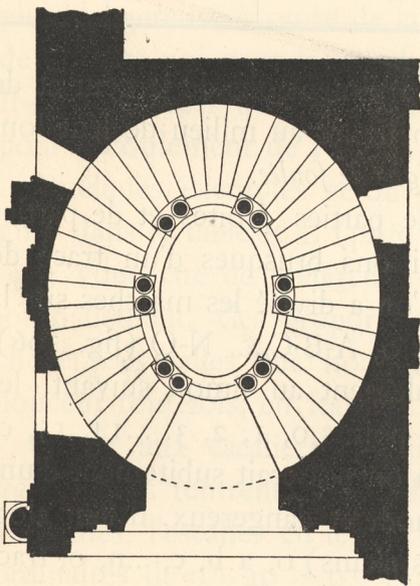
Plan de l'escalier ovale du Palais Barberini, à Rome.
